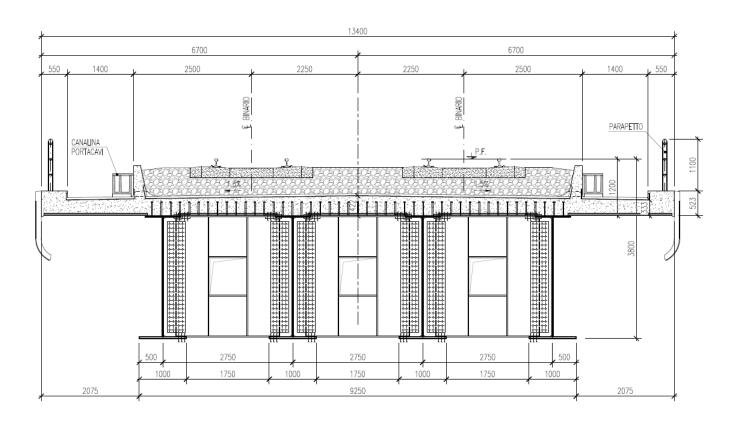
Sezione trasversale tipo dell'impalcato da 40 m (4 travi).
